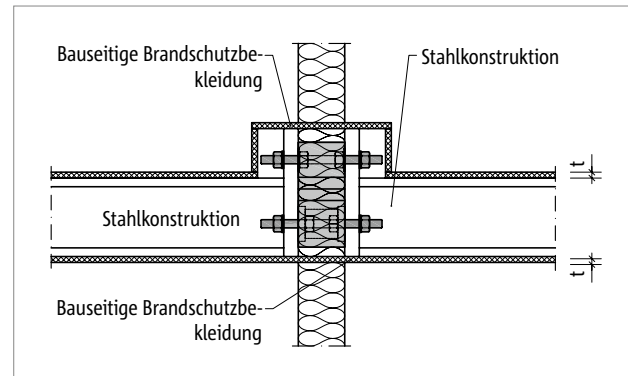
Brandschutz Schöck Isokorb® T Typ S: Bauseitige Brandschutzbekleidung bei überstehenden Stirnplatten; Schnitt
